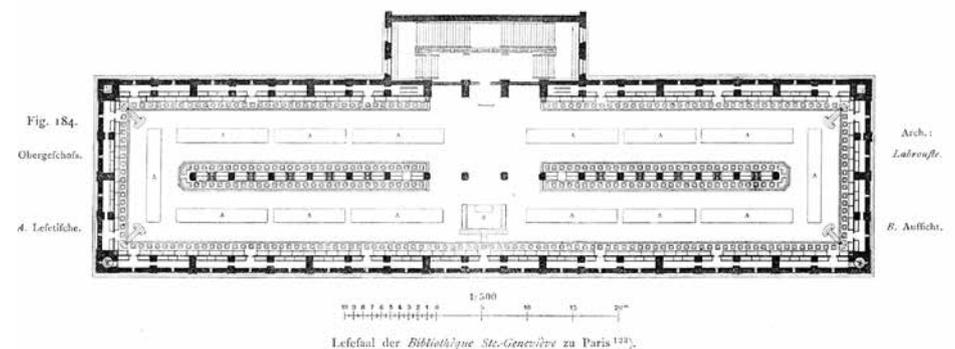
Grundriss des Lesesaales mit der Originalanordnung der umlaufenden Tische
